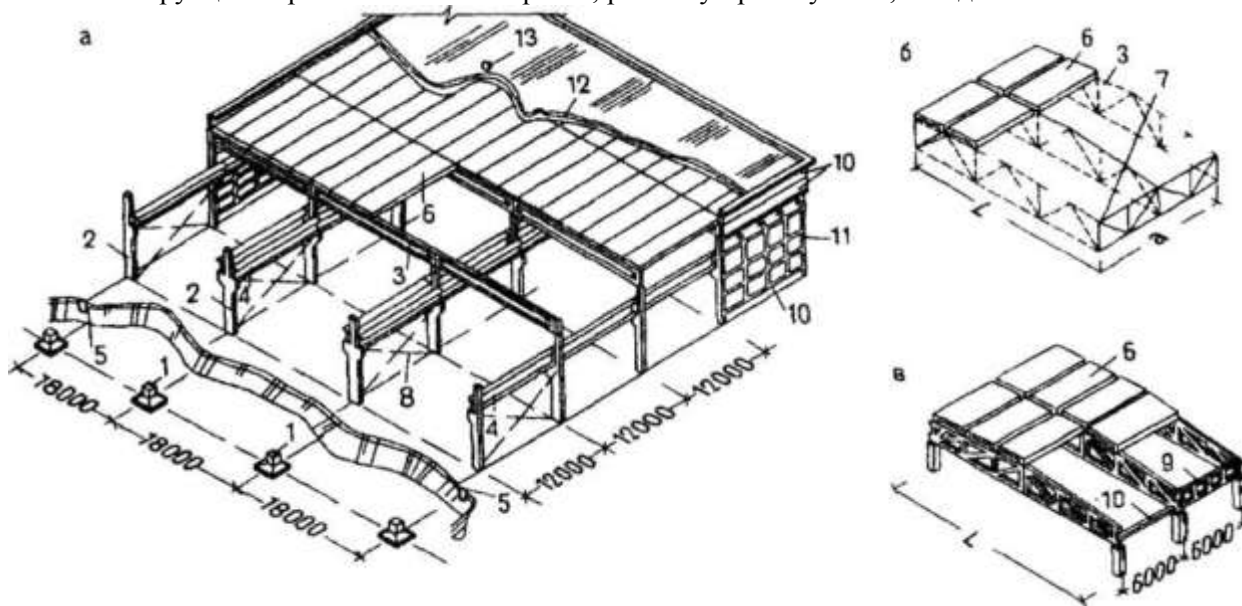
Основные элементы каркаса одноэтажного промышленного здания:
